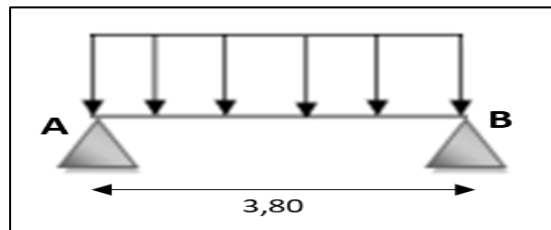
schéma statique de la poutrelle à 1 travée.
